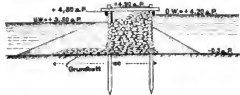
Querschnitt durch den unteren Fangedamm. (Grundbett und Kern bestehen aus Sanddicken, Vorschüttungen aus leichtem Sandboden.)
